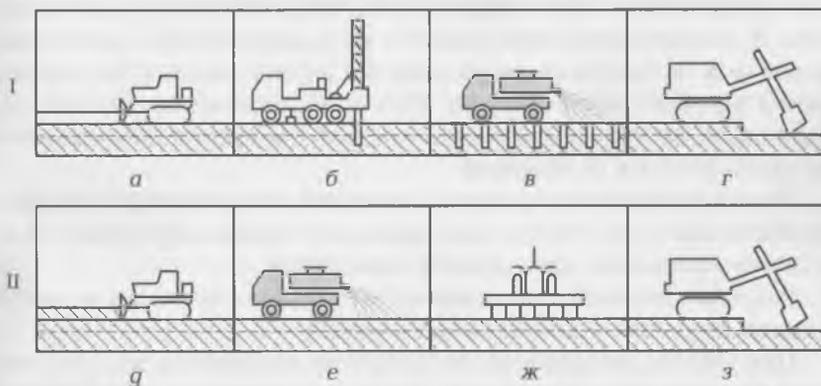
Схемы разработки с химическим оттаиванием грунта:
